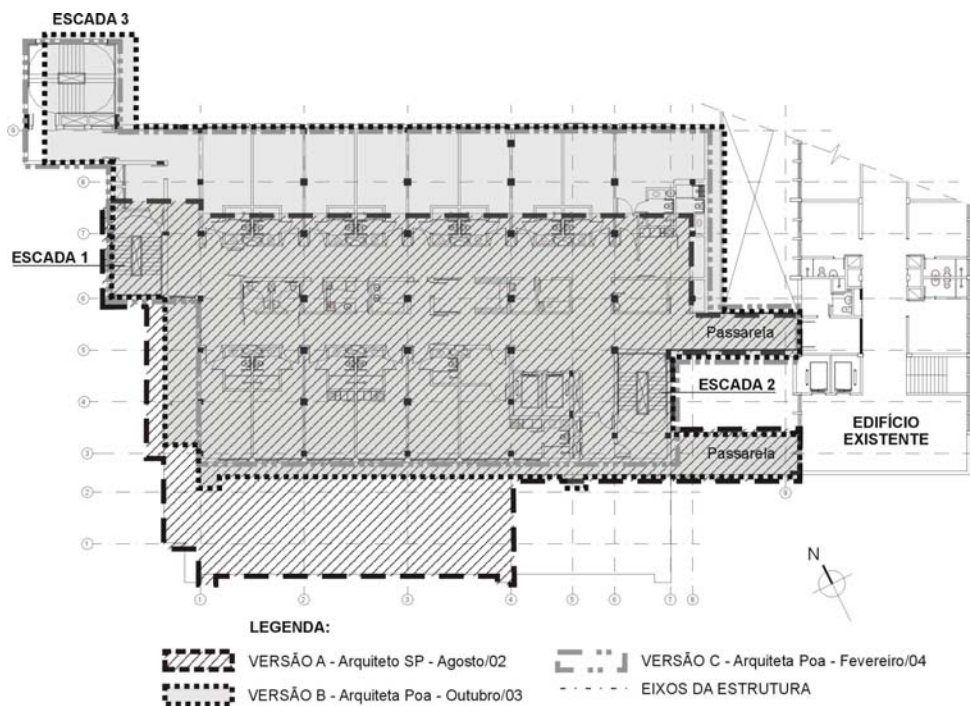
Plantas das três principais versões do pavimento tipo do edifício da internação ao longo do empreendimento, s/ escala.
